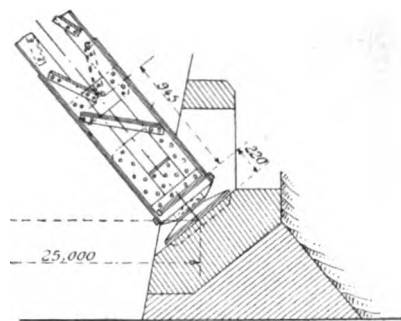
Détails d'un pilier à treillis et d'une voiture suspendue.
